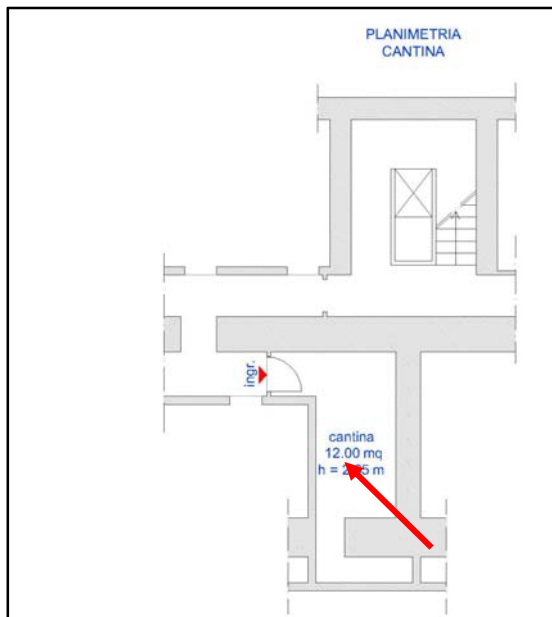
Plan. stato dei luoghi cantina del 11/12/2020
